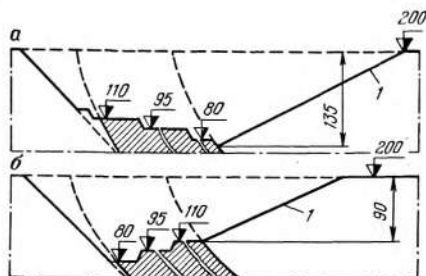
Схема к определению рабочей зоны вскрышного борта при отработке угольных пластов от кровли к почве (а) и от почвы к кровле (б):
